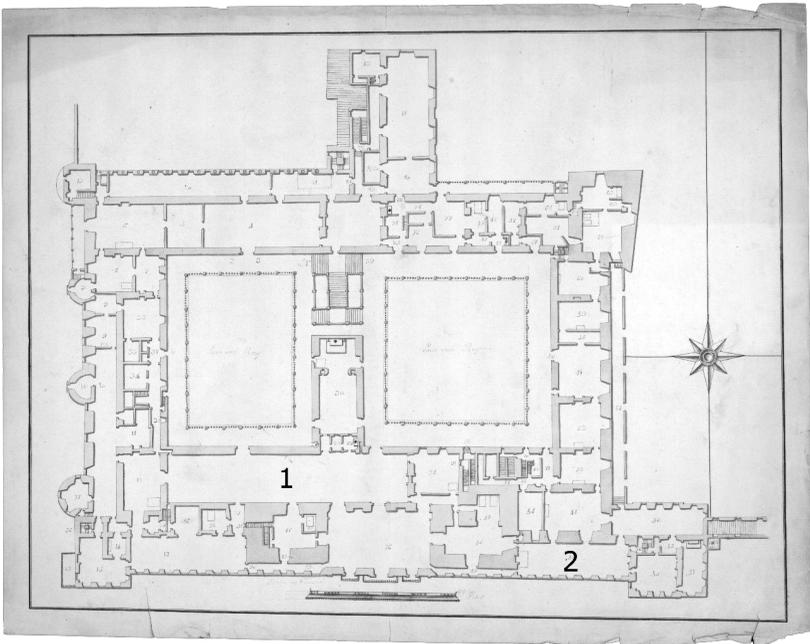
Plano de la planta noble del Alcázar de Madrid, Juan Gómez de Mora, 1626, Library of Congress (EE.UU.). Se señala el Salón de Comedias (1) y la Galería de la Reina (2)
